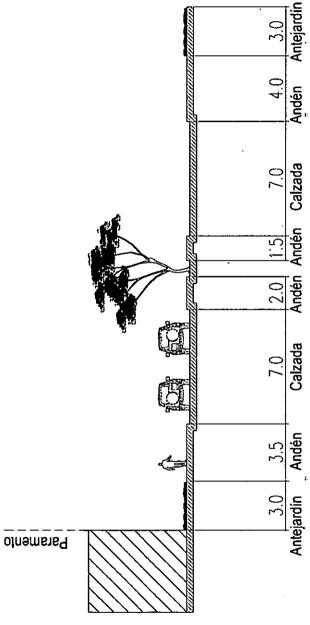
Sección vial Calle 31 entre carreras 87 y 87C. Fuente: Equipo técnico Plan Maestro API_39 Universidad de Medellín.
